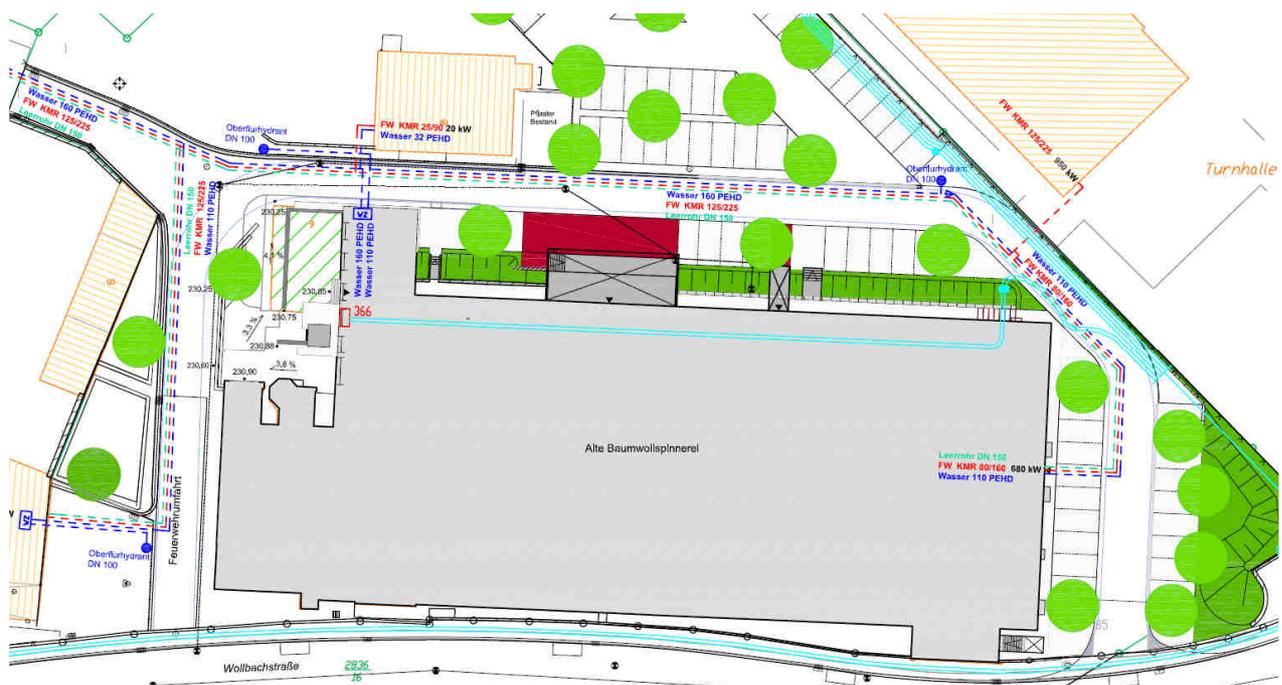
Übersicht Lageplan Gehrechte, Geh-/Fahrrechte, Feuerwehrumfahrrechte (Dienstbarkeiten)
